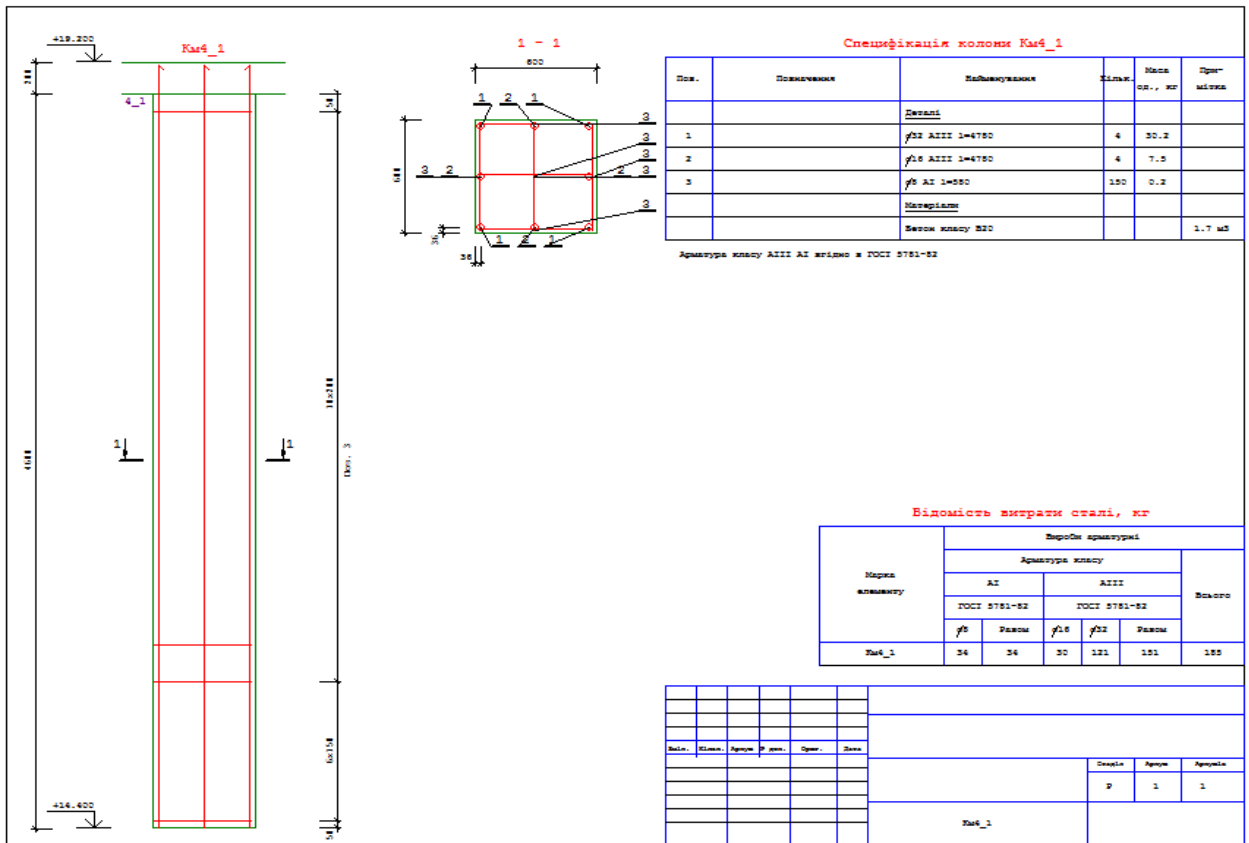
Варіант будівлі з плитним перекриттям. Колона К4-1. Креслення робочого проекту.
